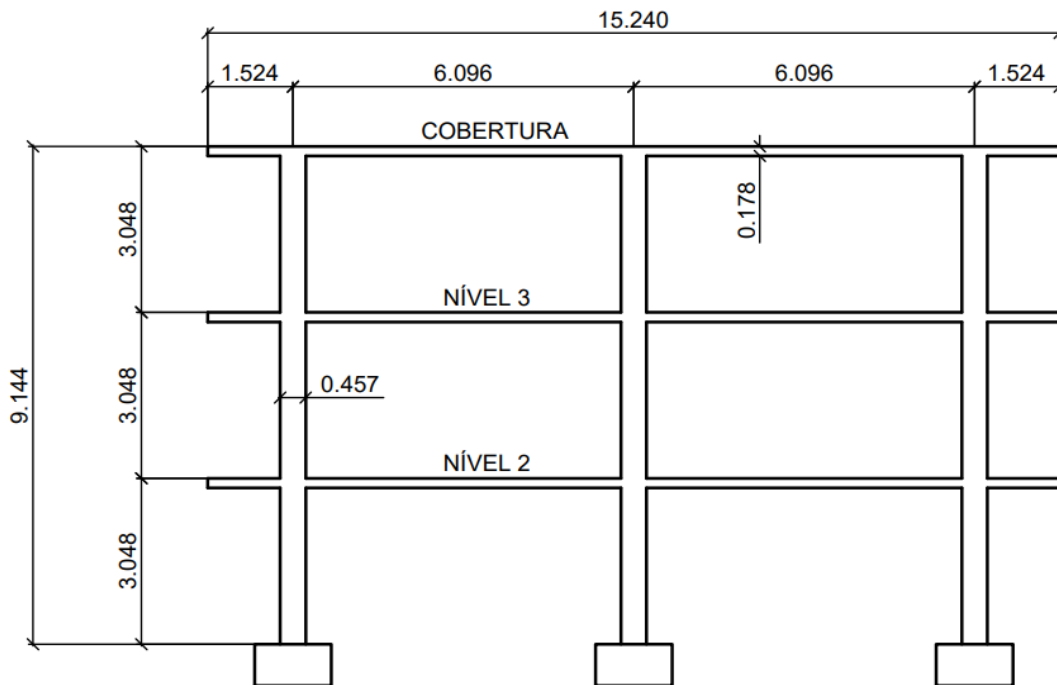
Vista lateral da estrutura, com cotas transformadas para o Sistema Métrico, com medidas em metros. Adaptado de Fick (2008).
